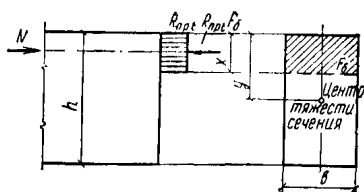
Схема усилий и эпюра напряжений в сечении, нормальном к продольной оси внецентренно-сжатого бетонного элемента, рассчитываемого без учета сопротивления бетона растянутой зоны
